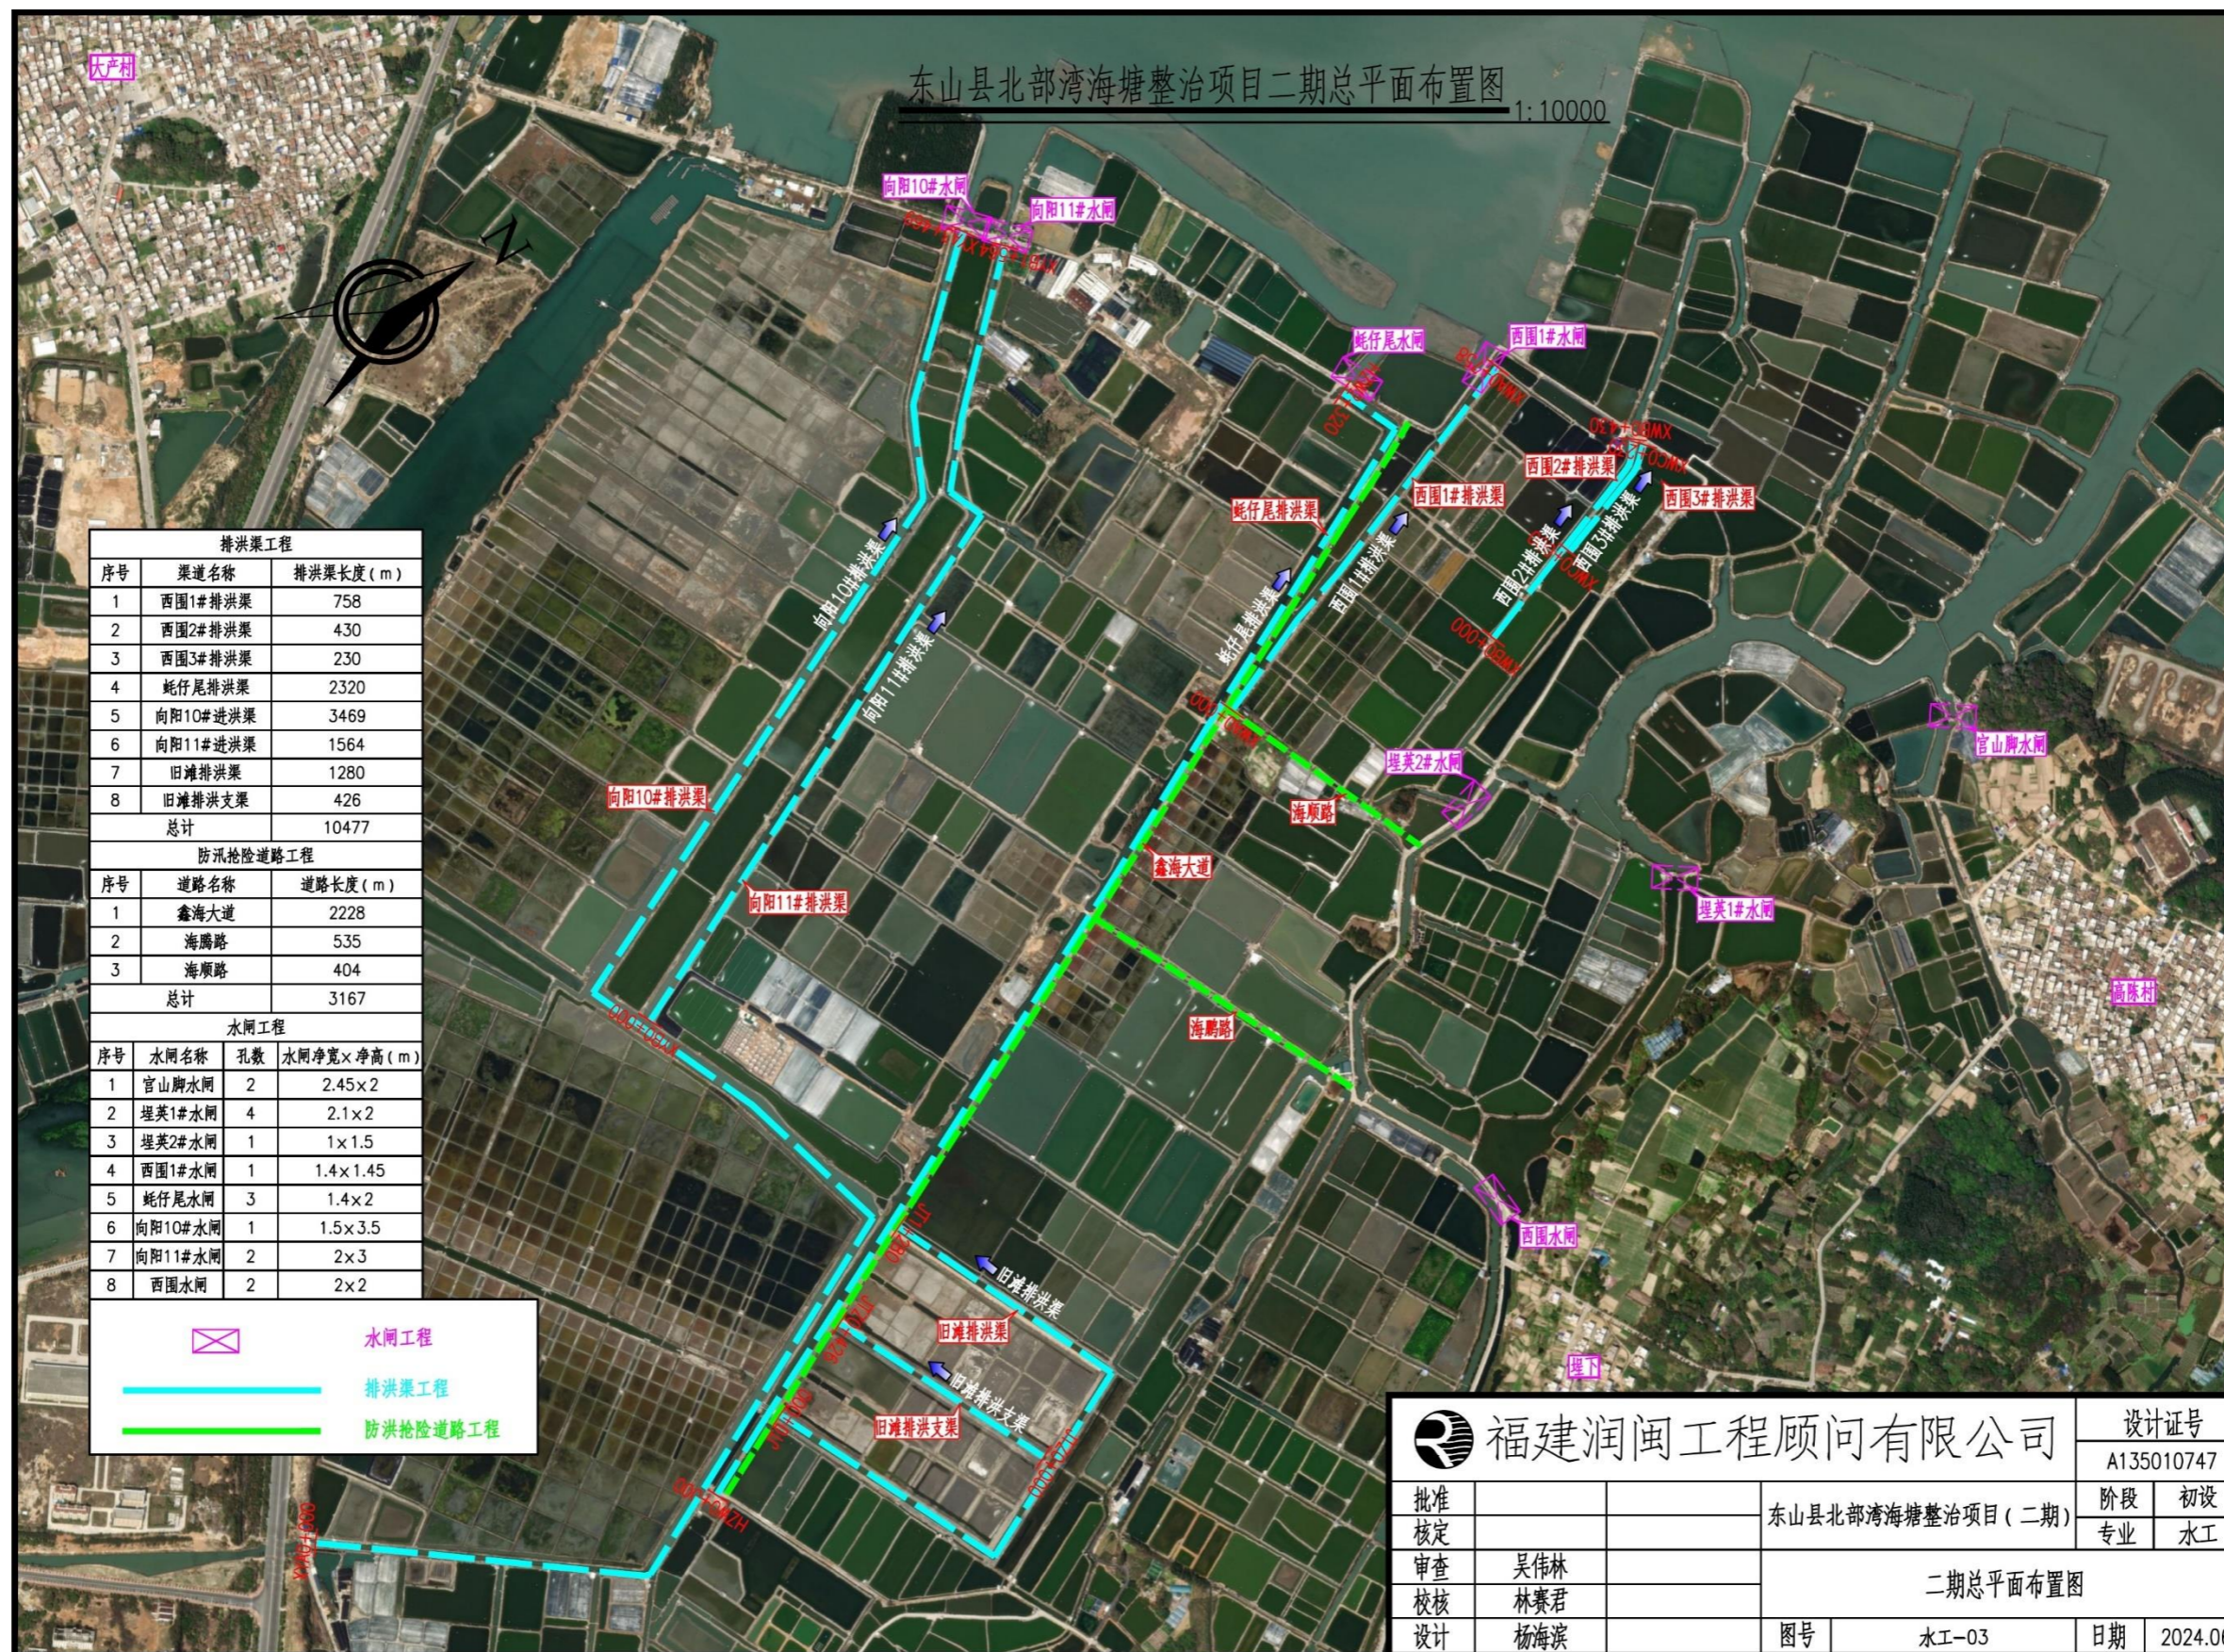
东山县北部湾海塘整治项目二期工程总平面布置图
